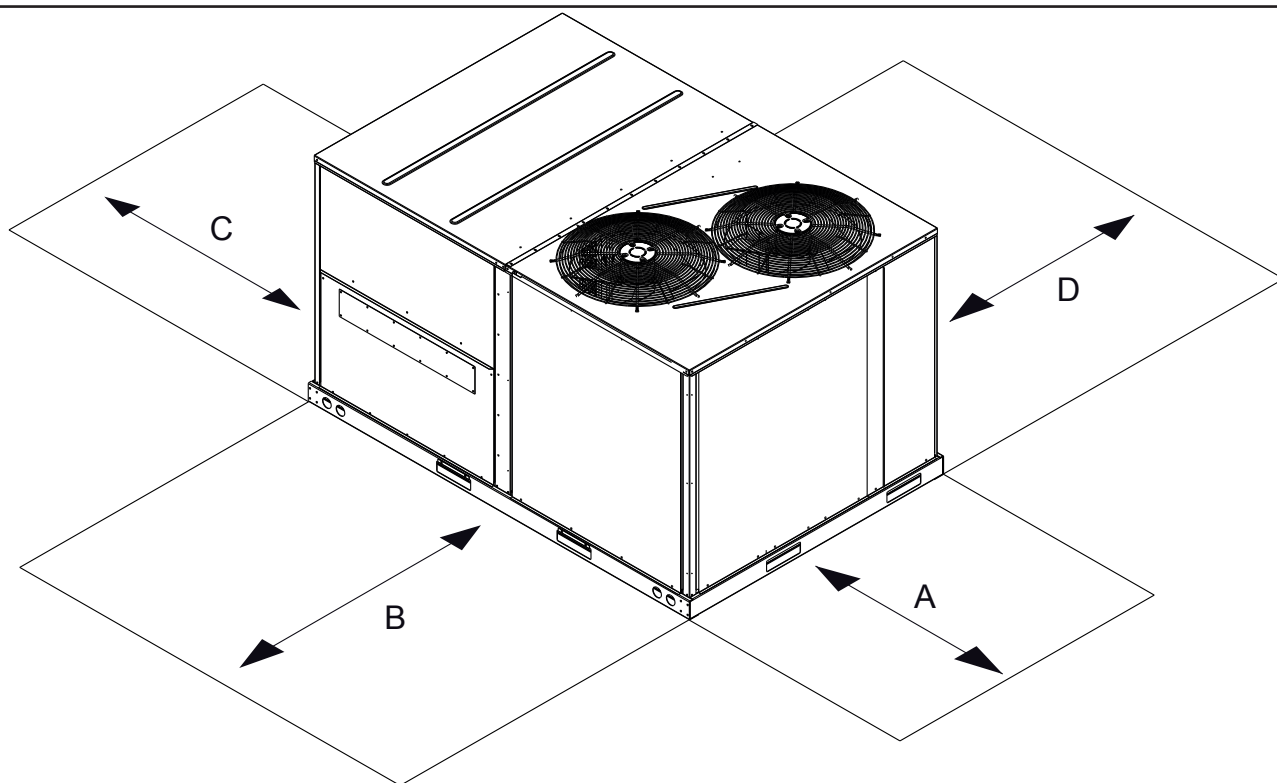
Desenho dimensional das unidades - 50TC_10-15
